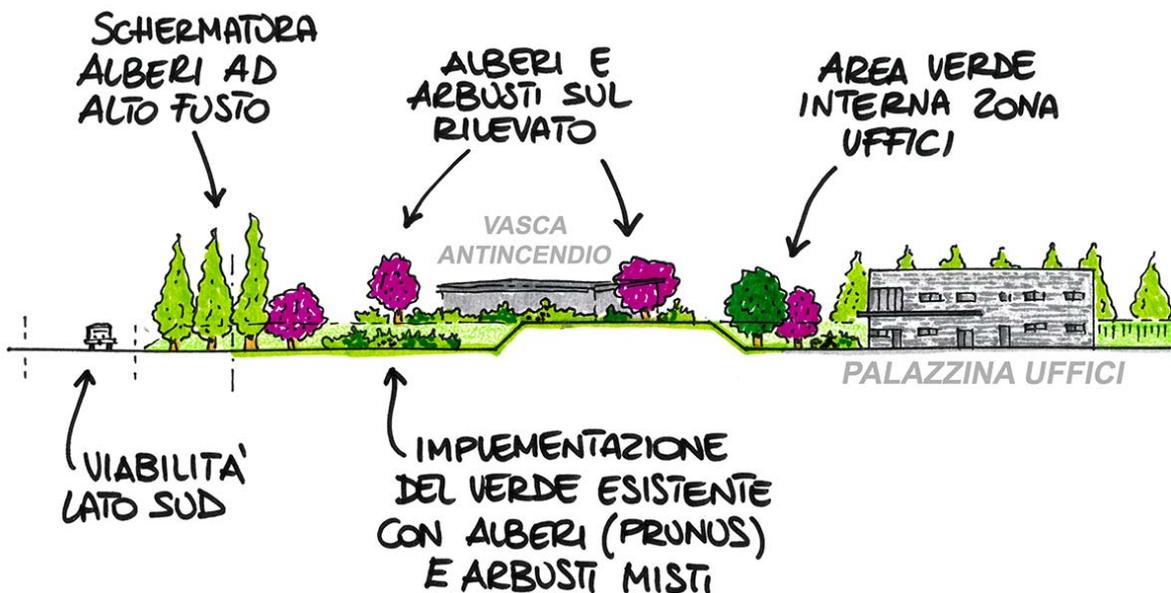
Schema degli interventi all'ingresso dell'impianto
